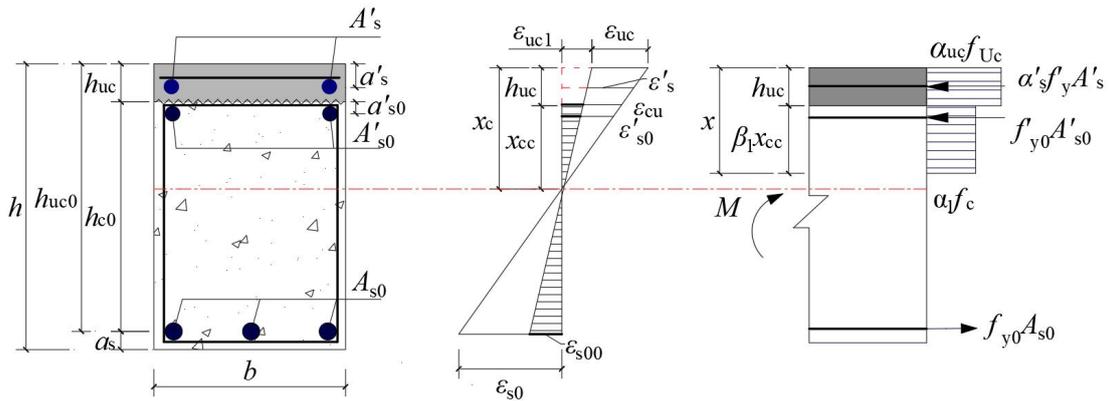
受压区加固矩形截面受弯构件正截面计算简图
